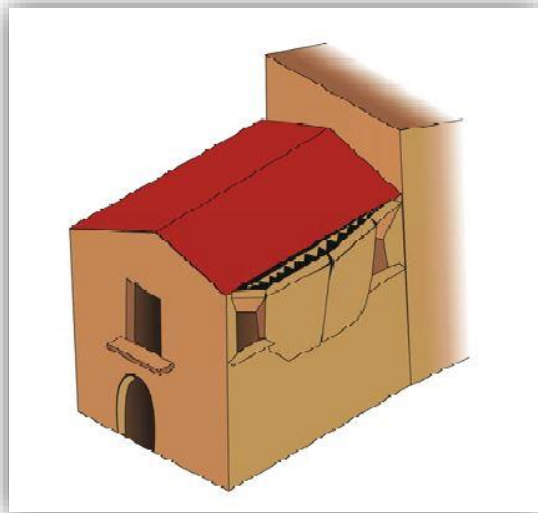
Rupture hors plan du mur entre 2 ouvertures due à la poussée de la toiture.
